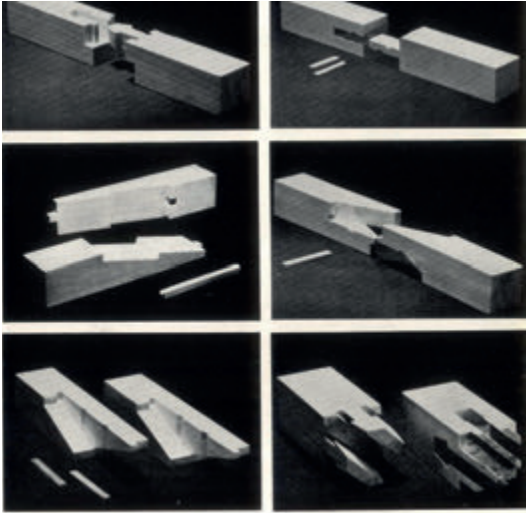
Despiece de detalle constructivo. El ensamblaje debía ser perfecto para que la junta funcionara correctamente.
